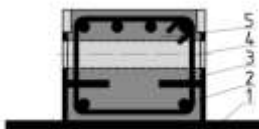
Поперечный разрез сталежелезобетонной балки.
